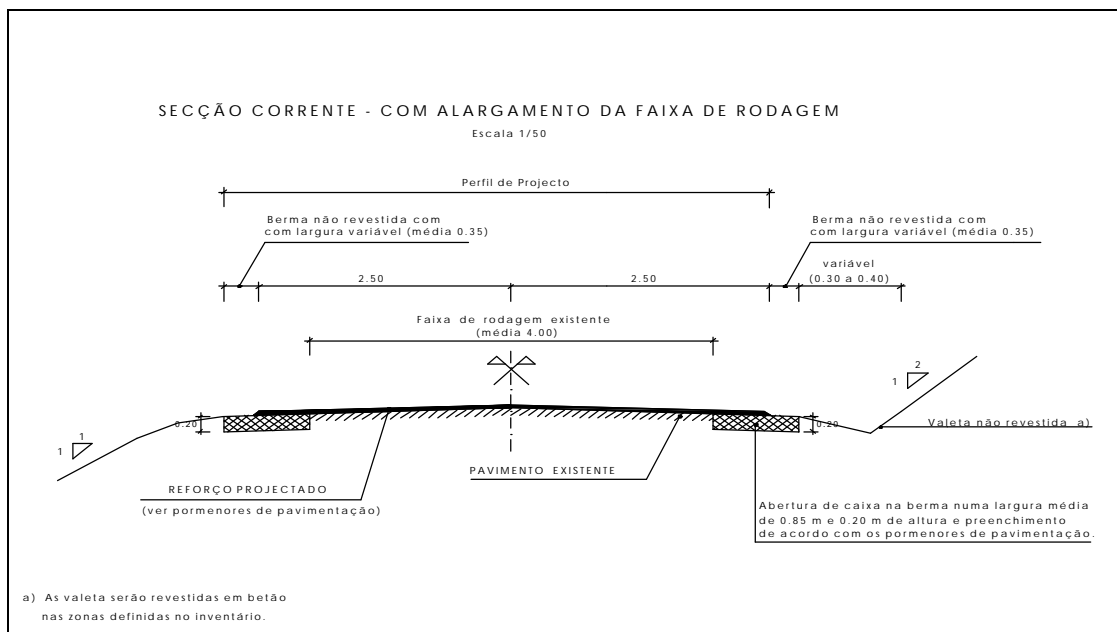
Perfil Transversal Tipo do alargamento da faixa de rodagem
